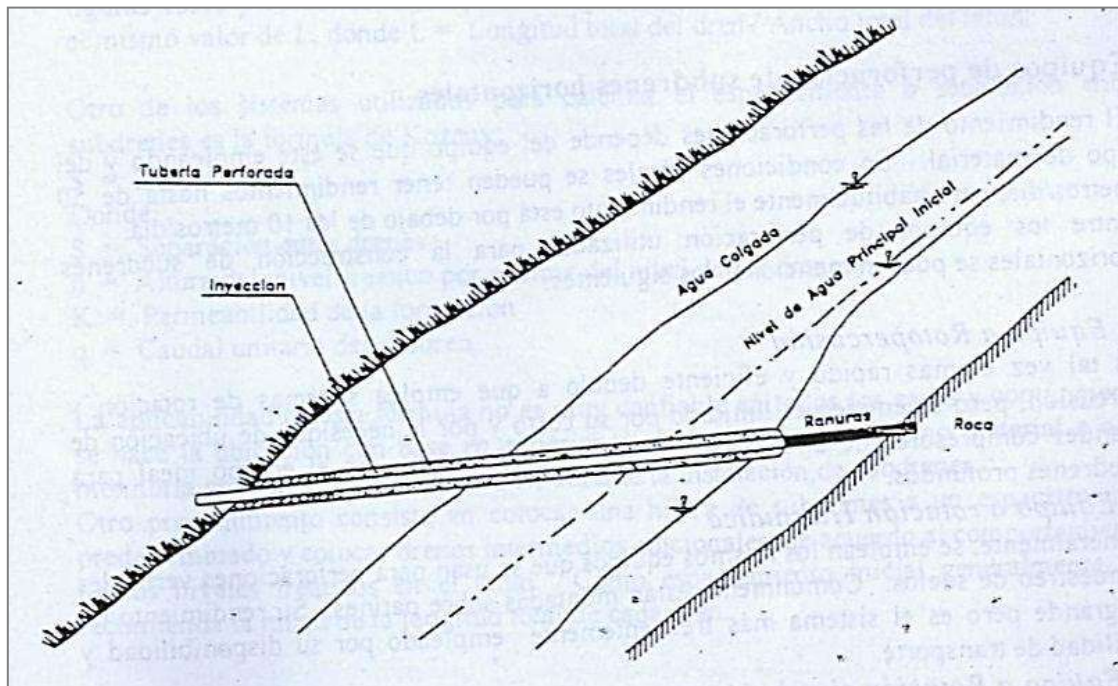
Subdrén de penetración diseñado para captar solamente en la punta interior
